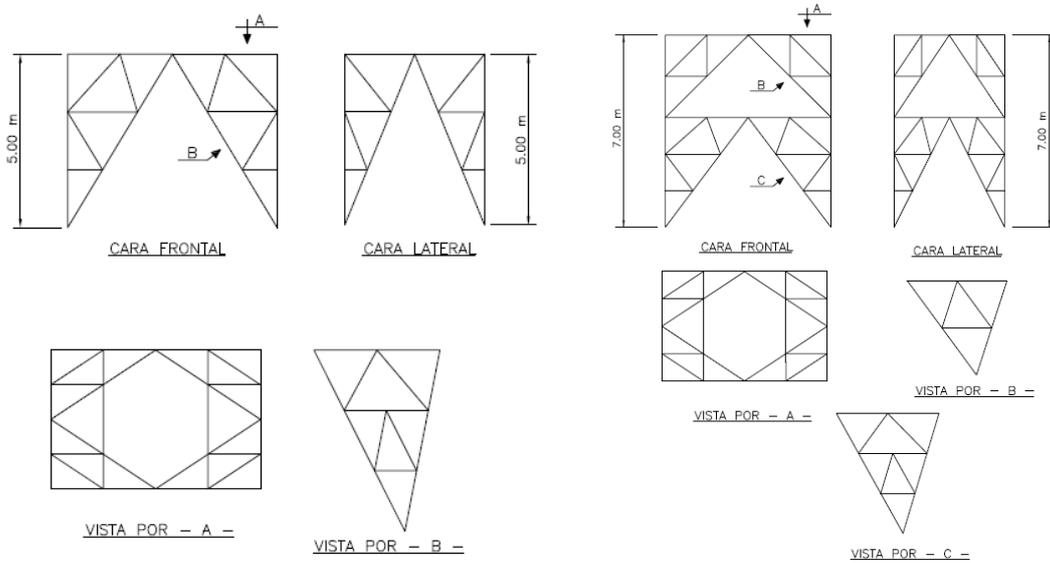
Detalles constructivos del recrecido de los apoyos (recrecido de 5 y 7 m). Fuente: Red Eléctrica
